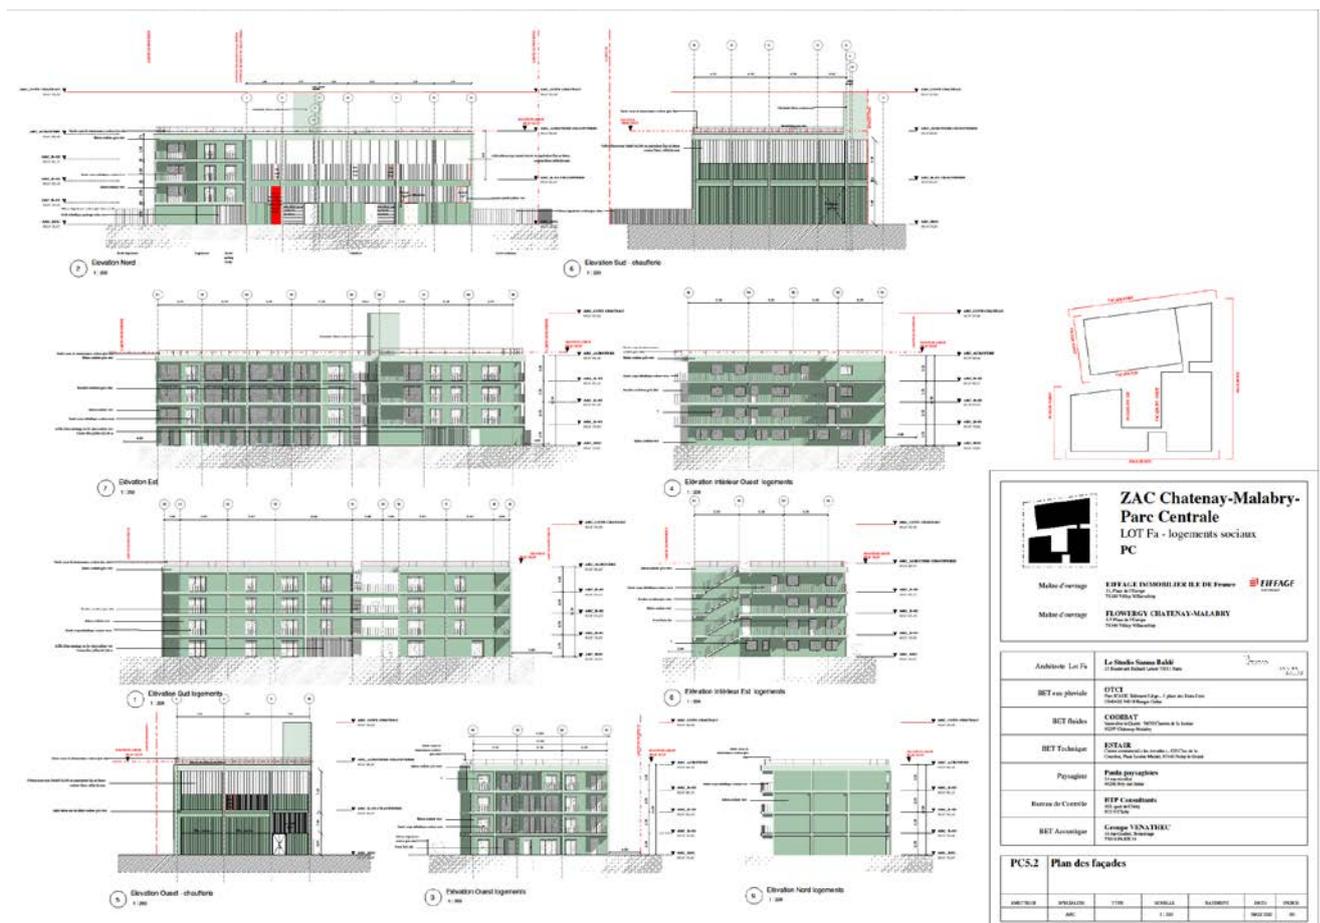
Plans de façade de la chaufferie centralisée et du bâtiment social dans le lot F
